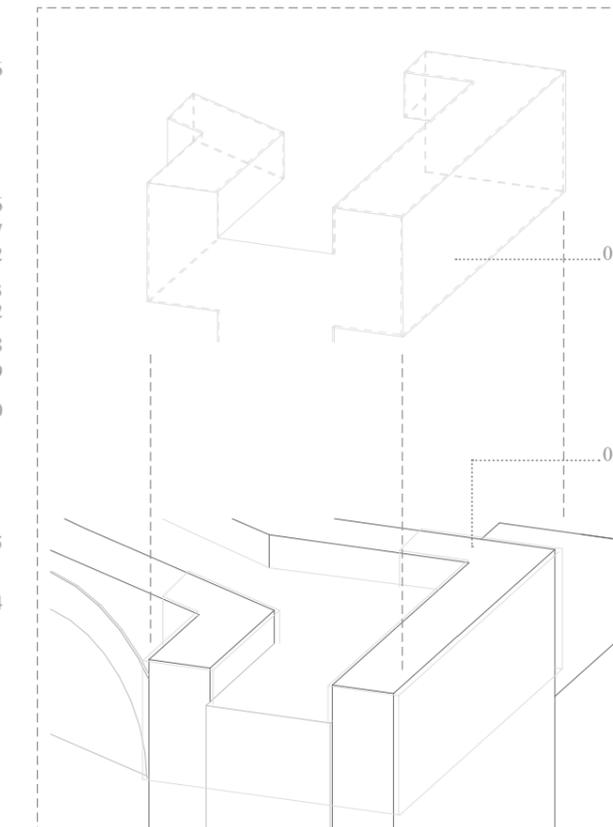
Implantación de molde acrílico (Autor, 2021)
